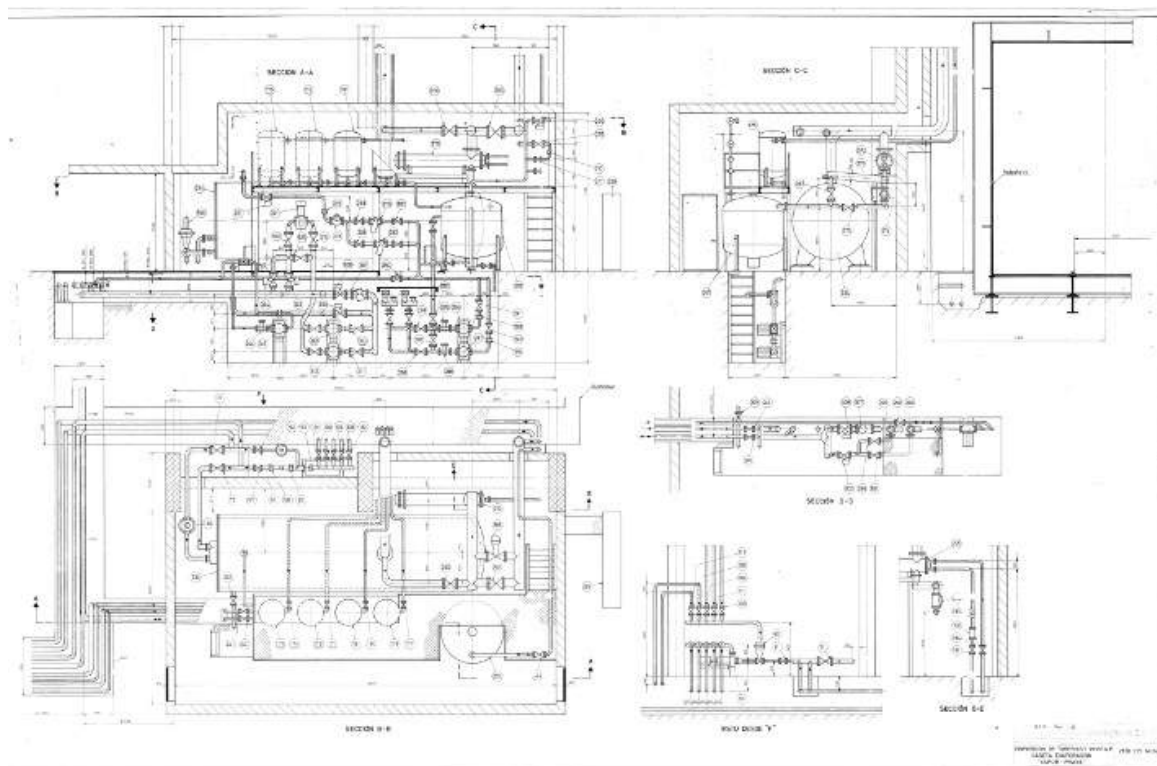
Plano de autoclave.Vista 2.
